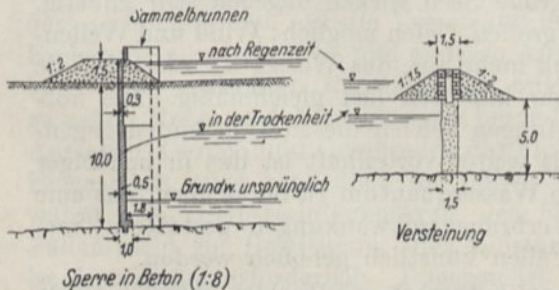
Grundwassersperrungen, nach »Die Bautechnik«, Jahrgang 1933.
